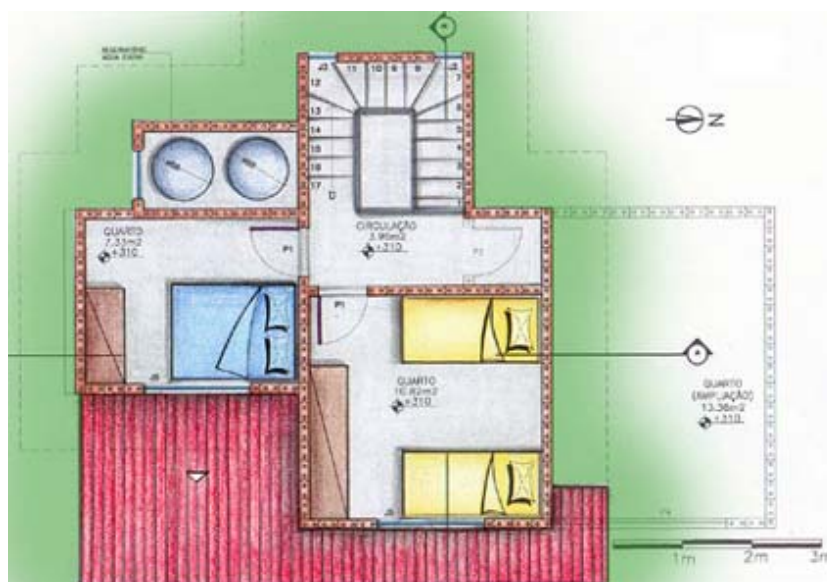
Proposta de Terra crua – Planta Baixa do segundo pavimento.
